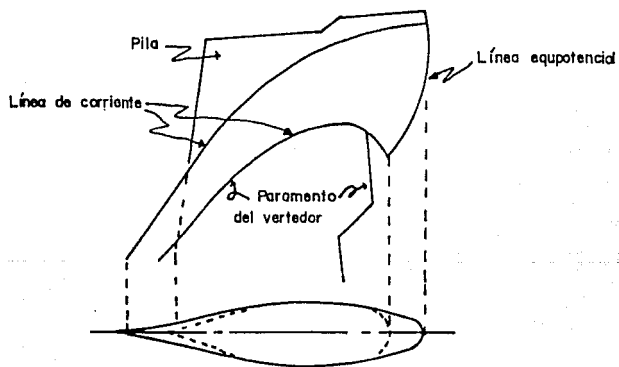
Sección y planta de un perfil tipo Joukowski, ensayada por L. Escande
